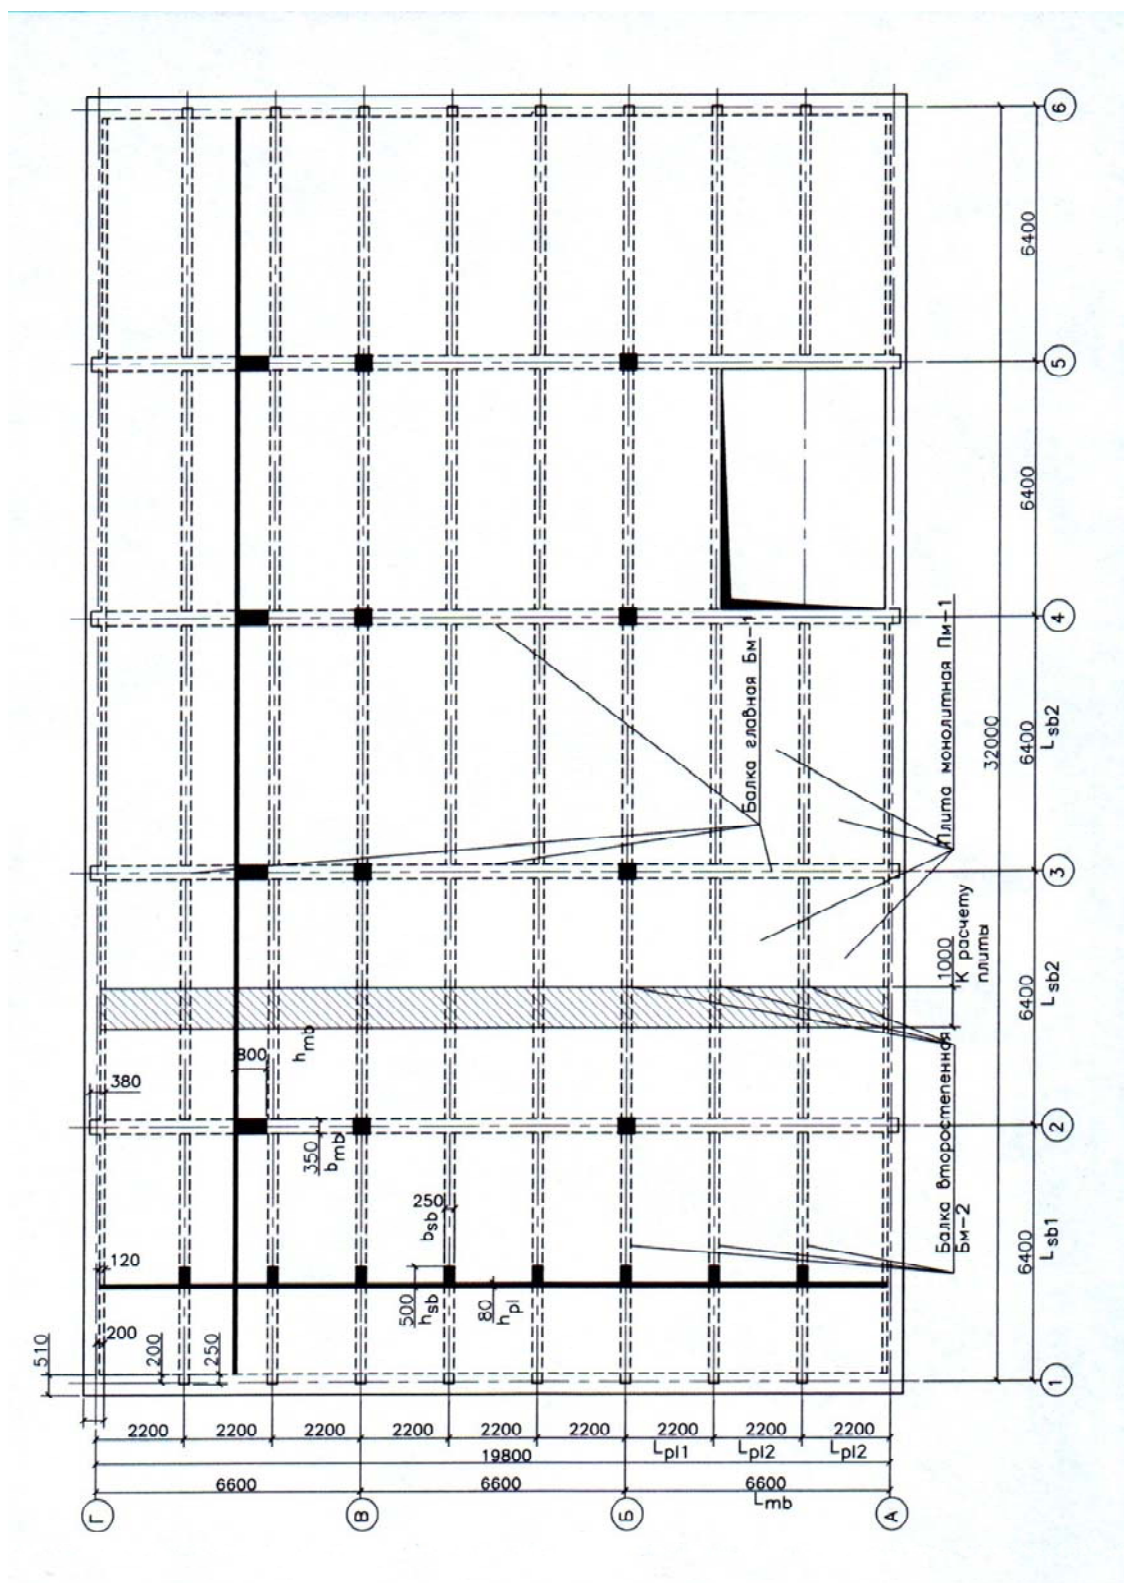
Конструктивная схема монолитного ребристого перекрытия
